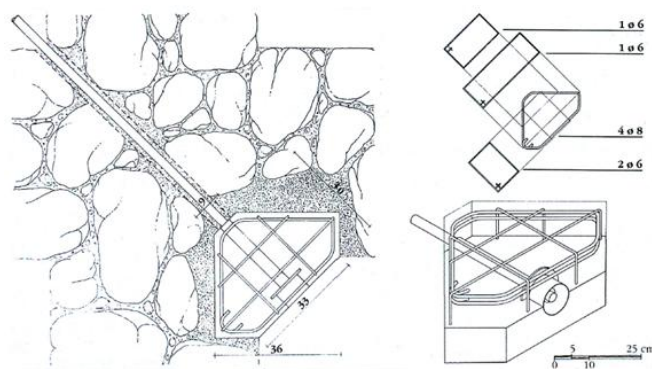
Exemplo de ancoragens de ângulo realizadas em betão armado pré-fabricado. [5]
